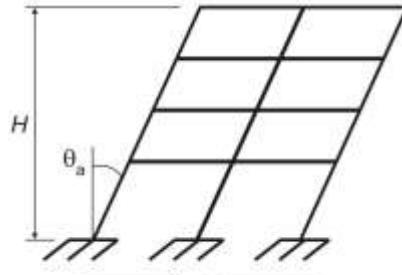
Desaprumo de elementos verticais (NBR 6118:2003 [1])
